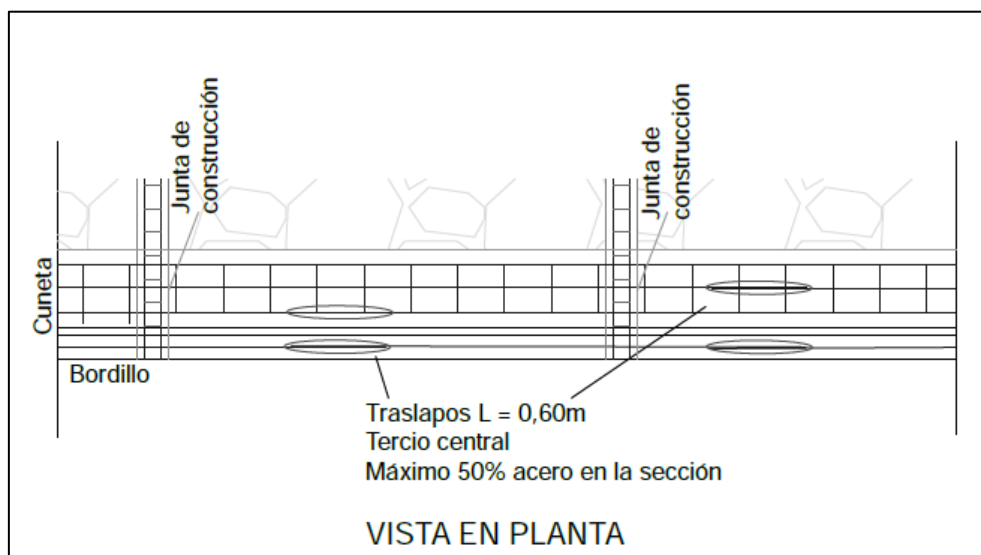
Junta transversal de construcción en la Berma-cuneta [3]
